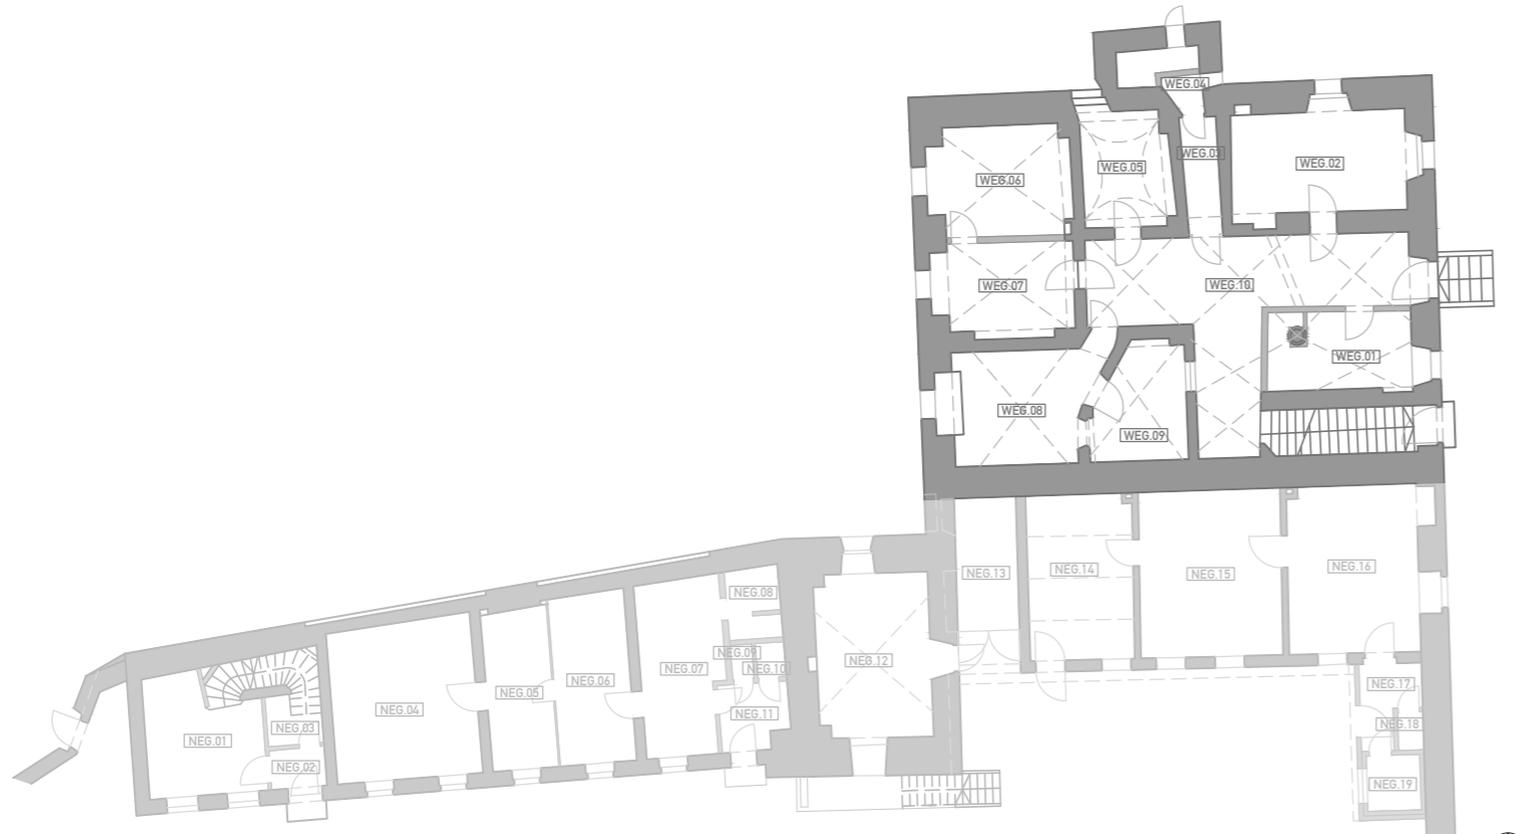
Wirtschaftsgebäude Bestand Grundriss Erdgeschoß
